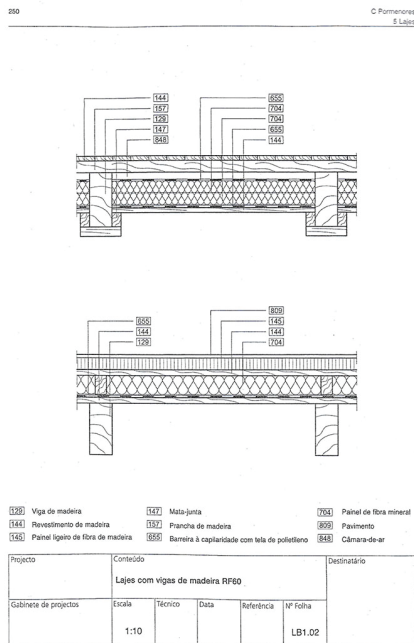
Pormenores construtivos de lajes com vigas de madeira, construção nova.
